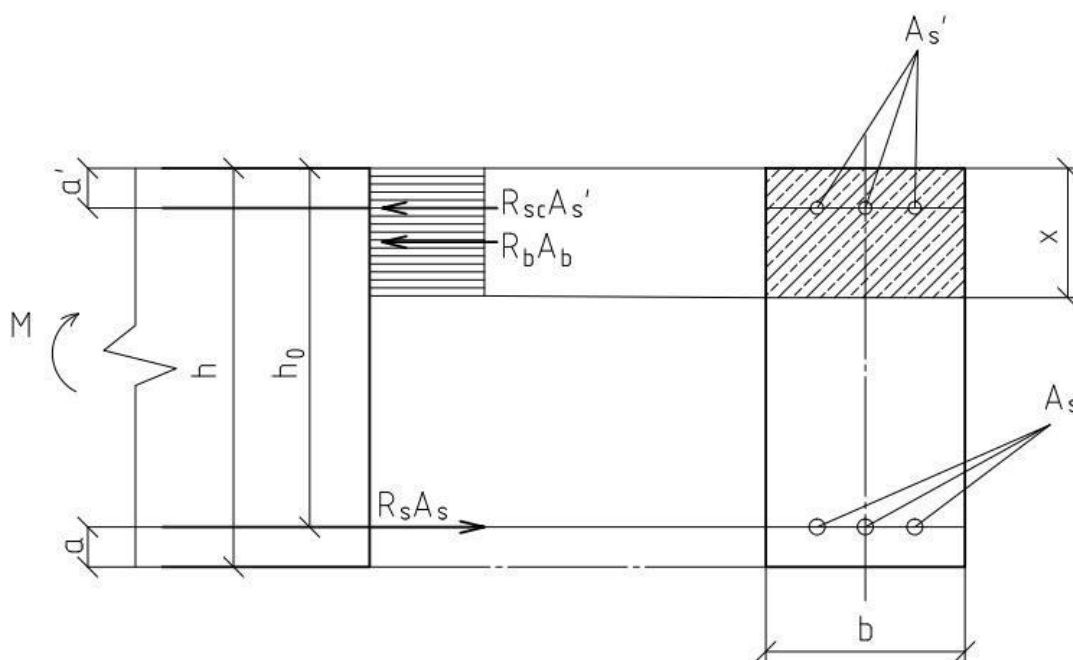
Схема усилий и эпюра напряжений в поперечном прямоугольном сечении изгибаемого железобетонного элемента
